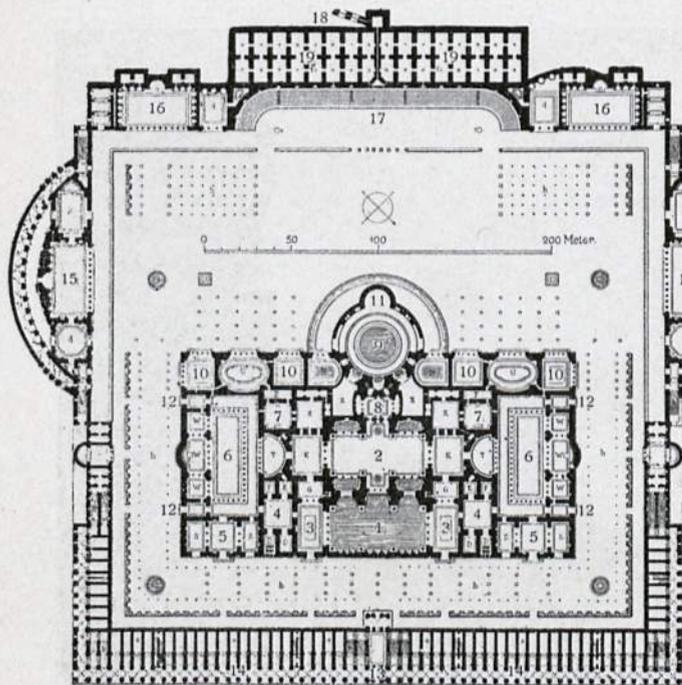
Grundriß der Caracalla-Thermen. Nach Gailhabaud.
